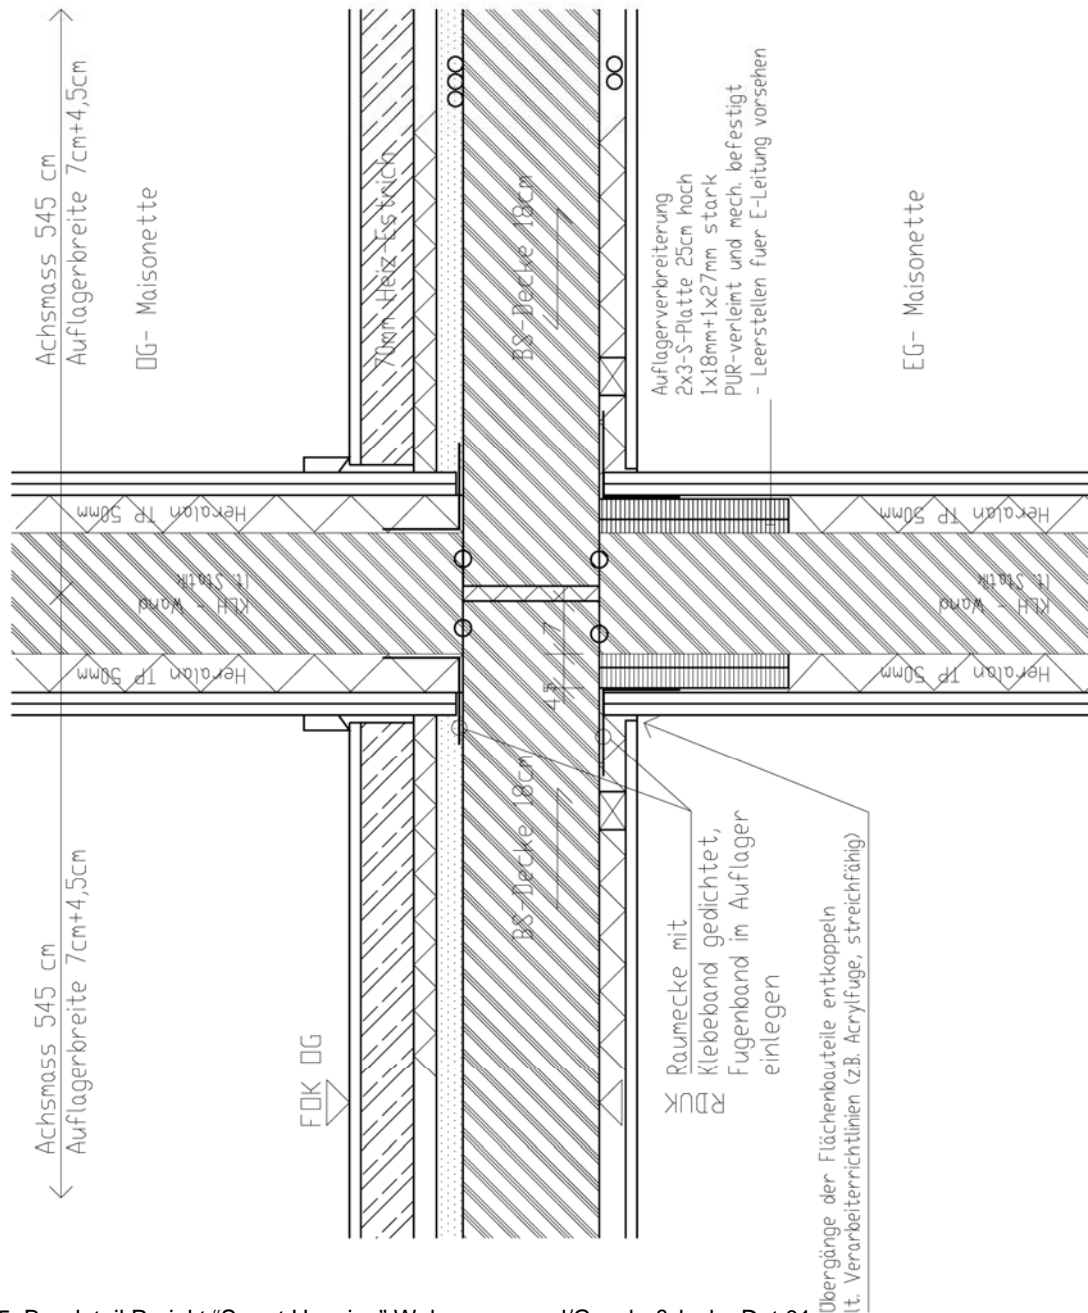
Baudetail Projekt "Smart Housing" Wohnungswand/Geschoßdecke Det.01
